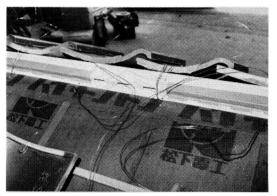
施 工 状 況 (試験体を取り付け,対象外部分を 密閉した状態)
